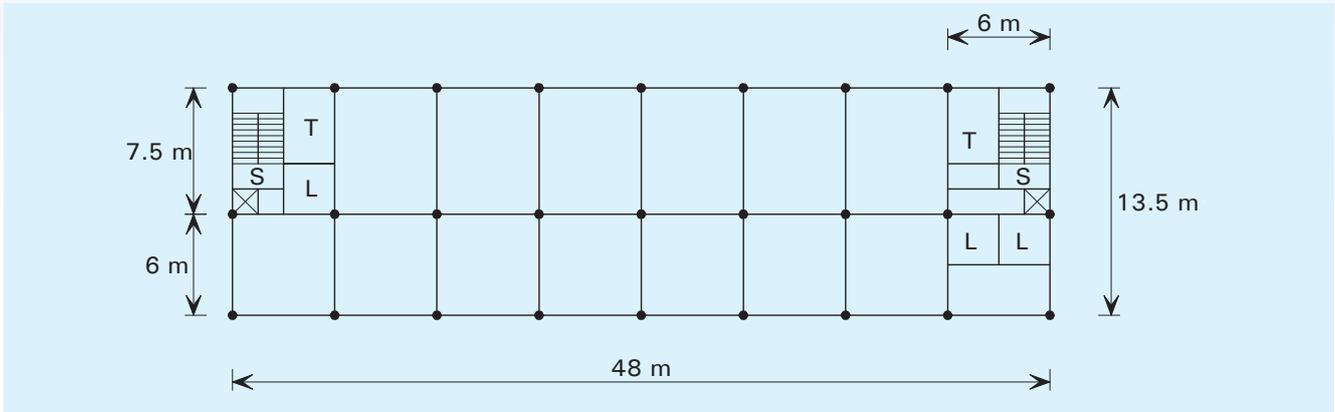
Сетка колонн здания с естественной вентиляцией помещений
